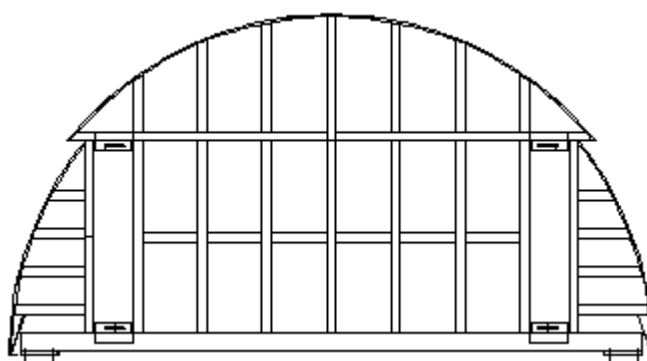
Viga curva reforzada con las partes móviles desplazadas hacia adentro
